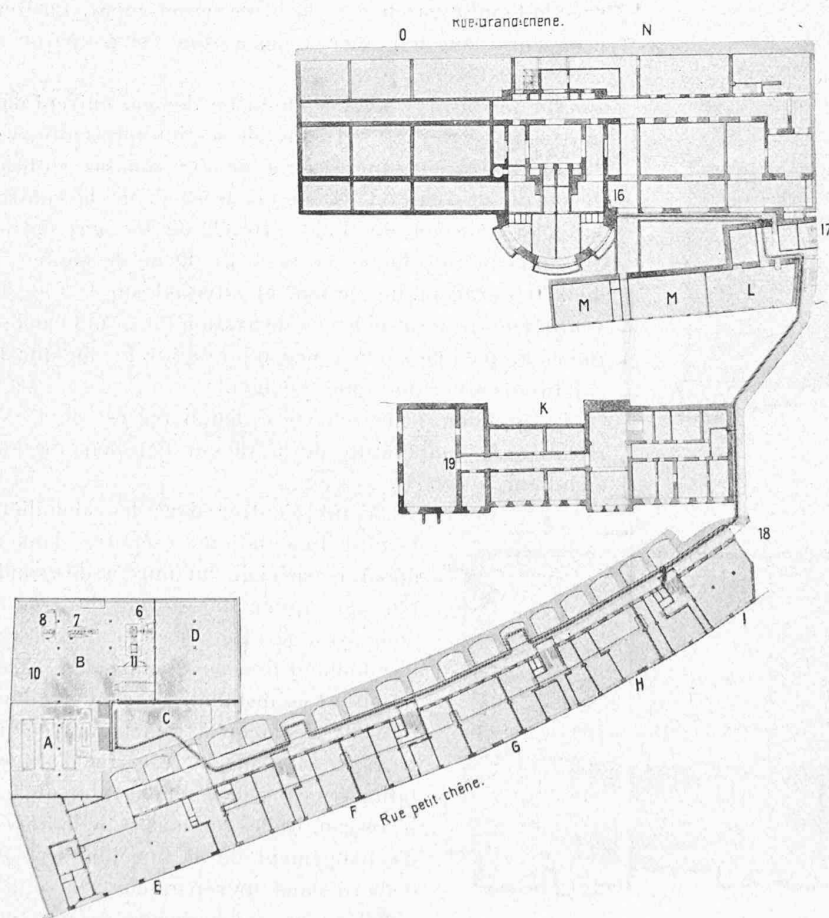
Plan général du sous-sol. — 1 : 200.
